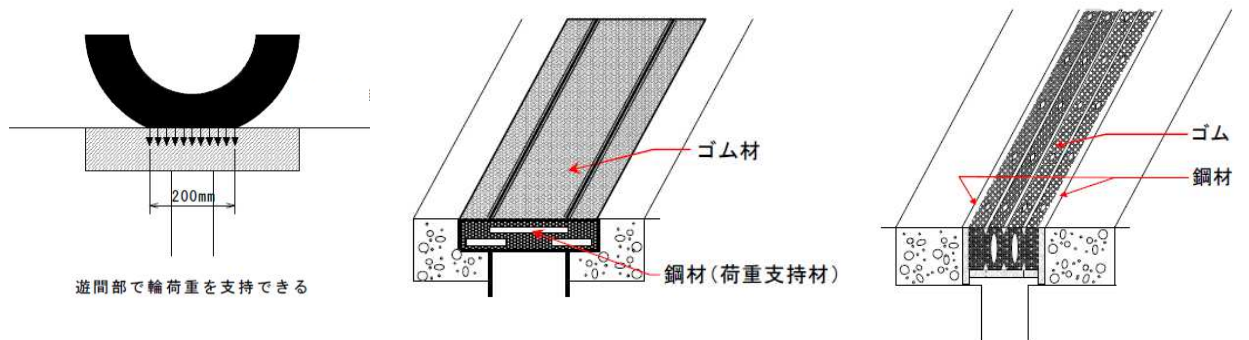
荷重支持型ゴム製伸縮装置の概要図
